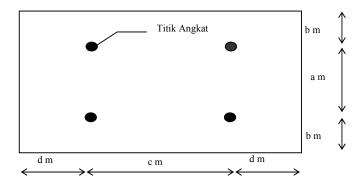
Pemodelan Beban Plat Pracetak Saat Pengangkatan
